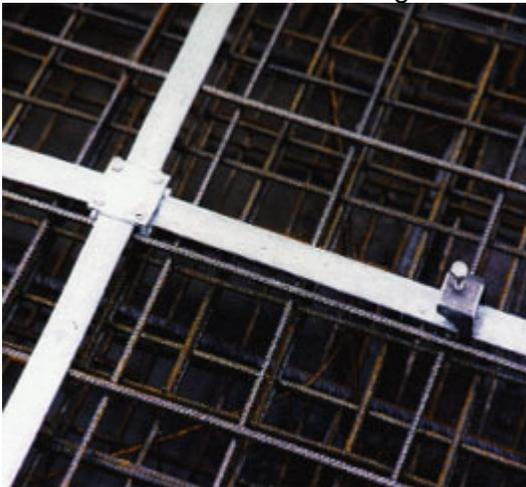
Schraubverbindung zur Verbindung des Fundamenterders mit der Bewehrung
